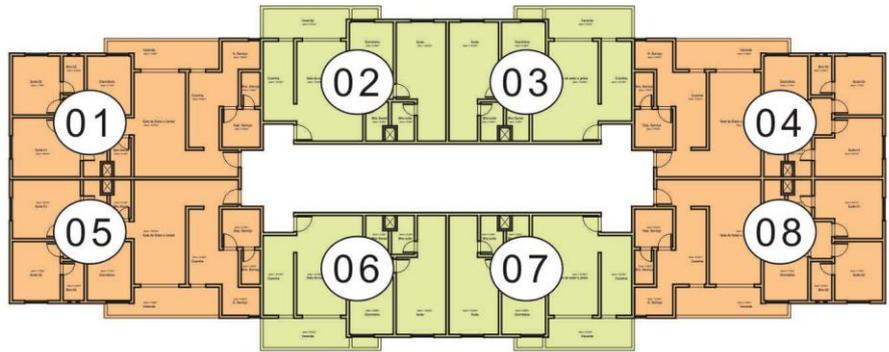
Planta Baixa do Pavimento Tipo das Torres implantadas no empreendimento Chácaras Montenegro.
